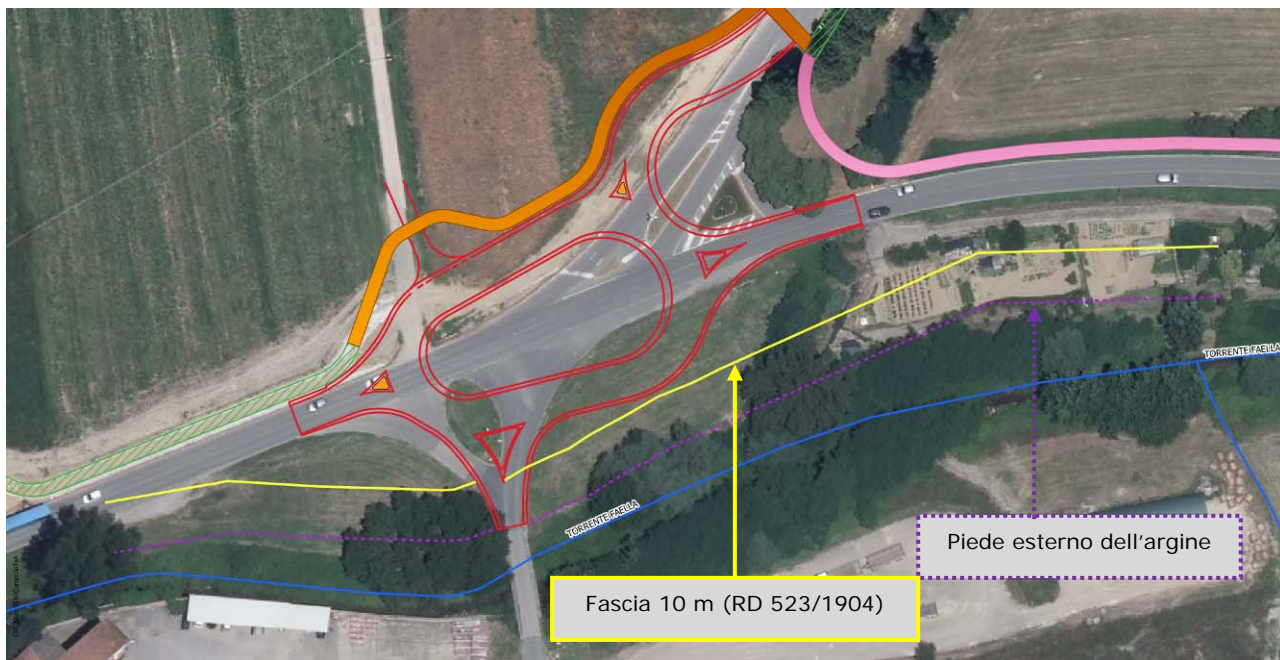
Planimetria rotatoria e fascia rispetto RD523/1904.
